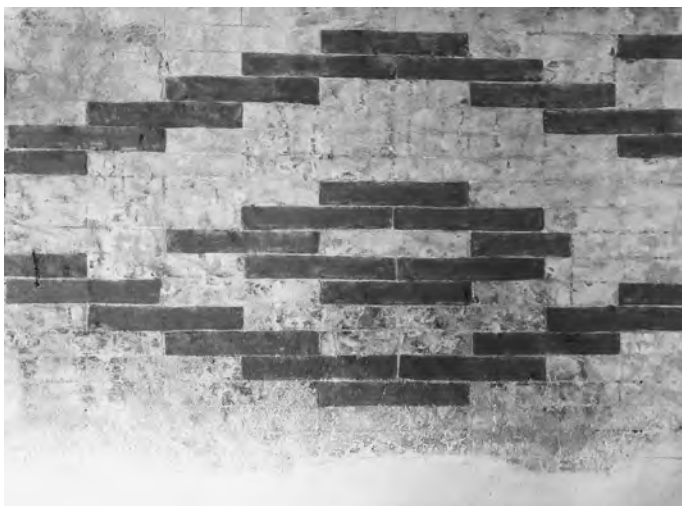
Dettaglio della finta cortina dipinta in rosa e rosso scuro: disegno 'a pettine' ai lati delle paraste ioniche del piano nobile rimessa in luce con il cantiere. Foto Aurea Sectio.
